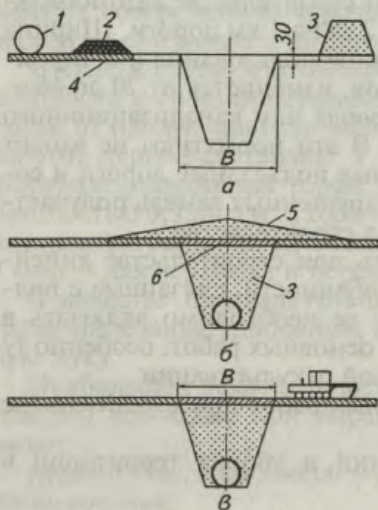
Совмещенная схема строительства трубопровода и рекультивации нарушенных земель:
